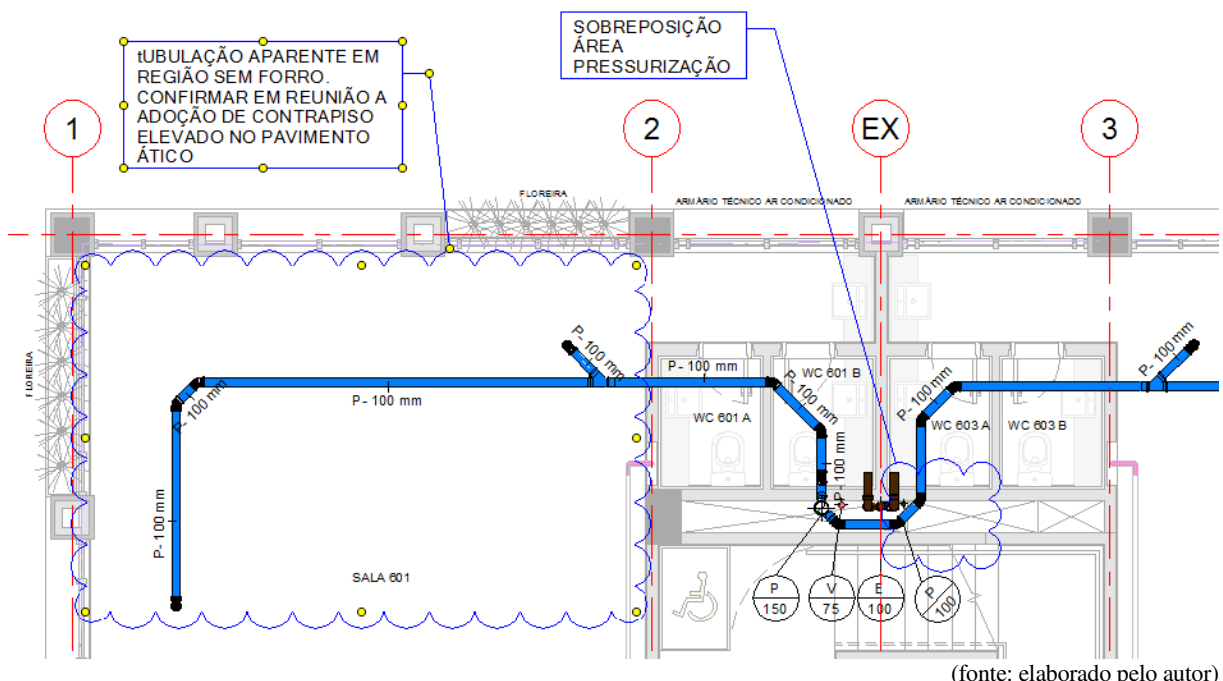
Relatório Compatibilização DWF - Perspectiva do conflito da drenagem do pavimento ático no 6º Pavimento - Anteprojeto.
